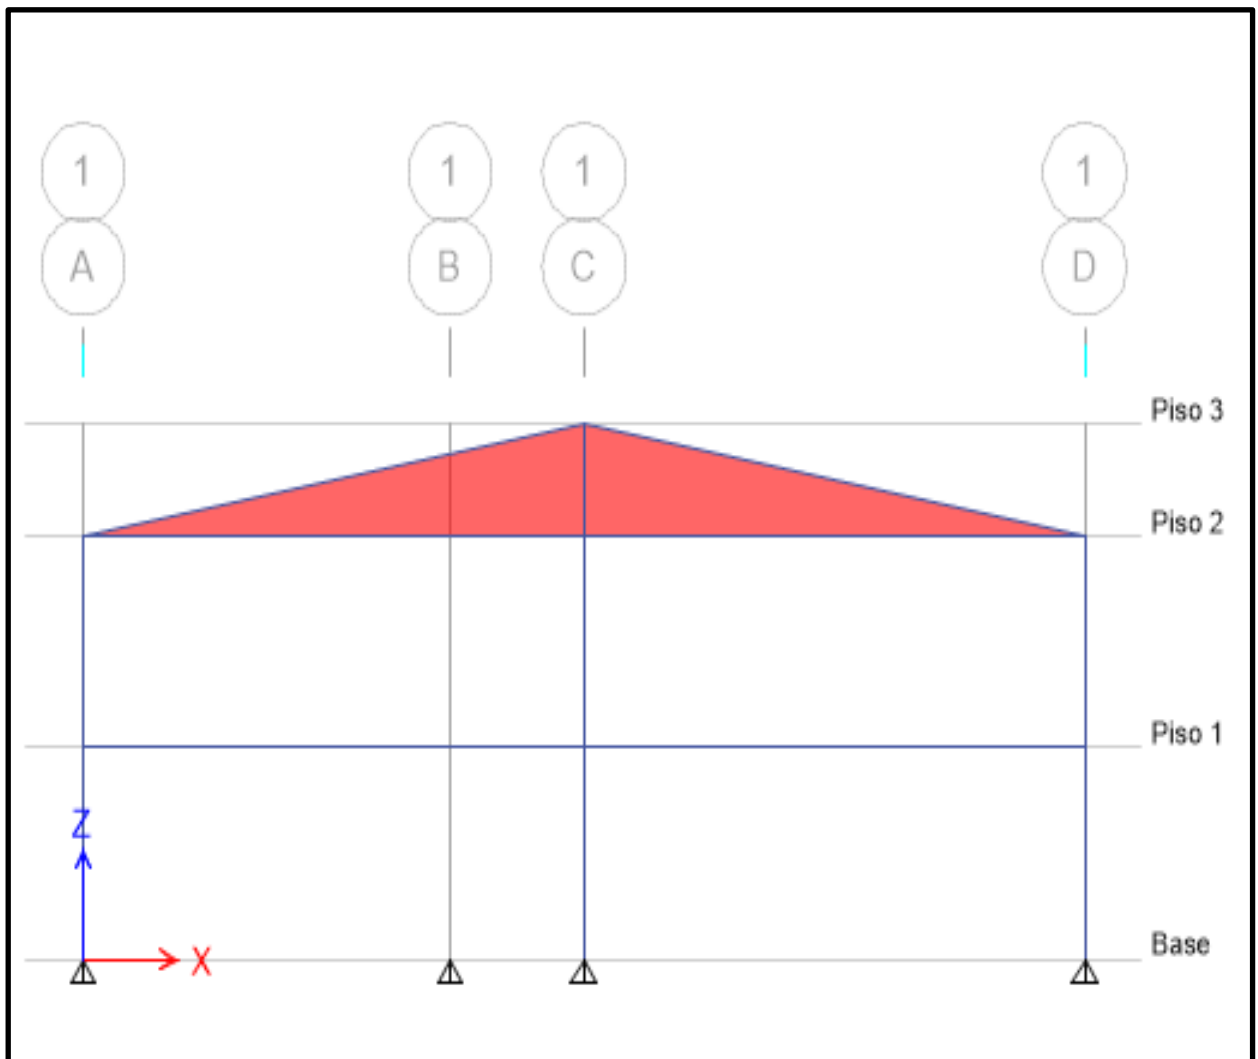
Modelamiento de la Edificación - Vista en Planta
